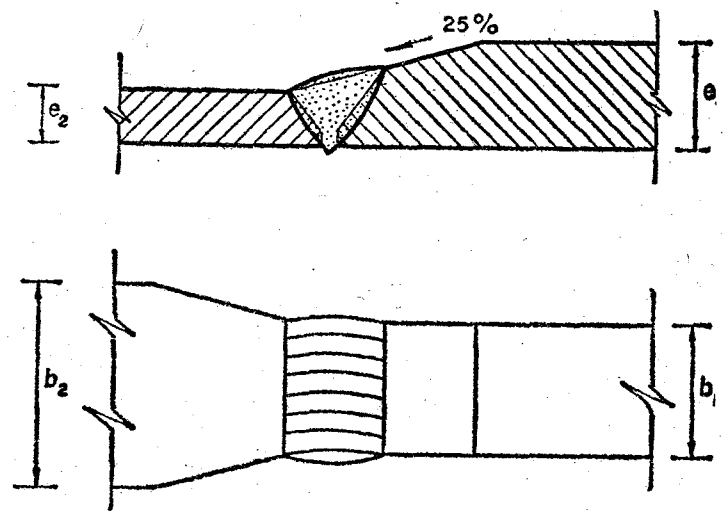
Soldadura a tope de piezas de distinta sección
